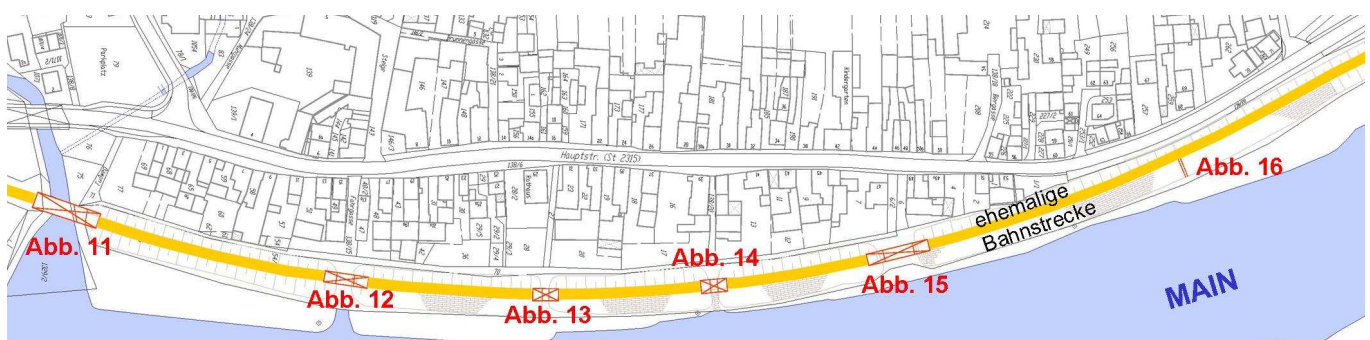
Lageplan Bahndamm, verändert aus [Unterlagen WWA AB]
